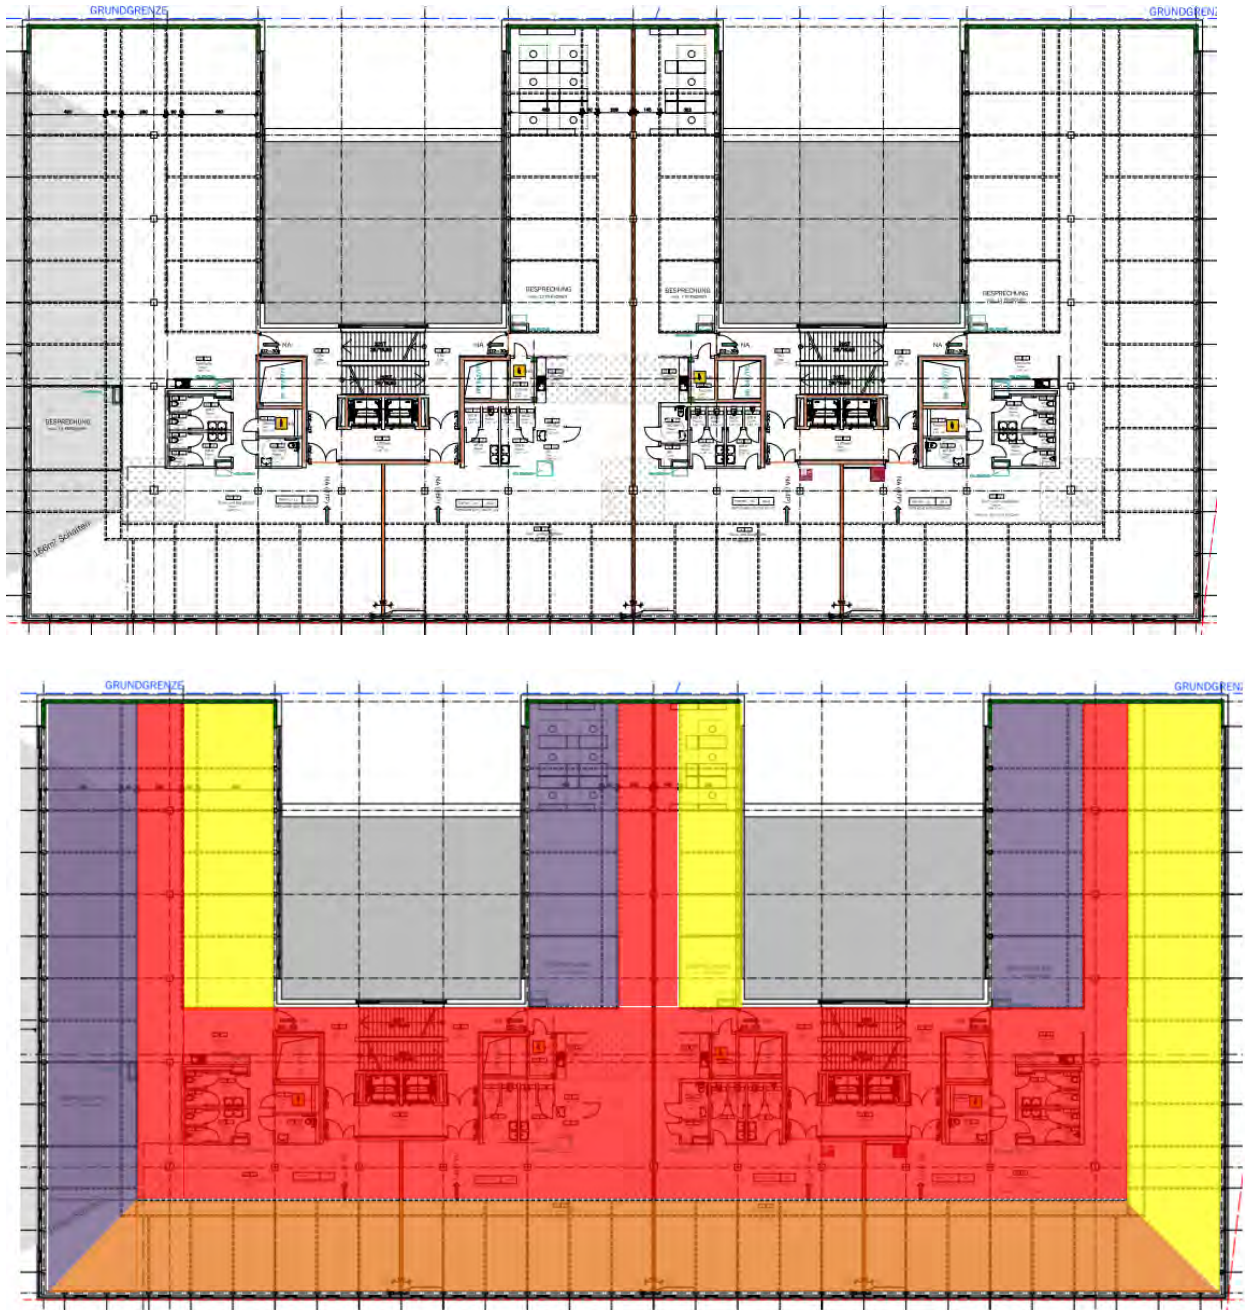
Minimale Zonierung (7 Fassadennahe Zonen + 1 Kernzone)
